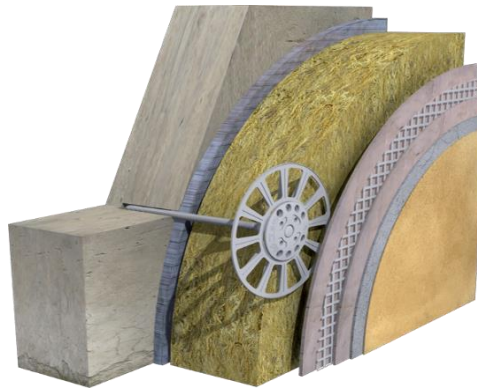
Технологія утеплення фасаду будівлі
